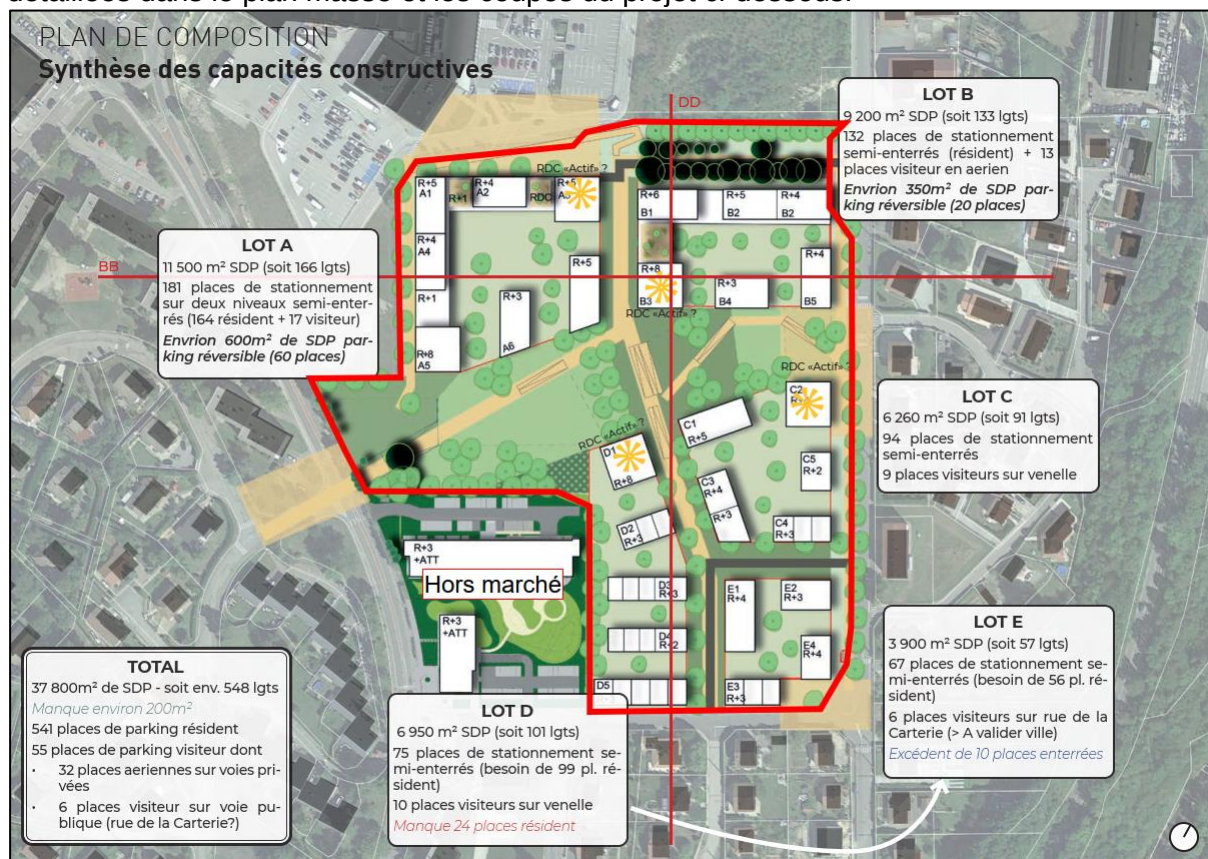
extrait du plan masse du projet (source : Insolites architecture, avril 2023)
